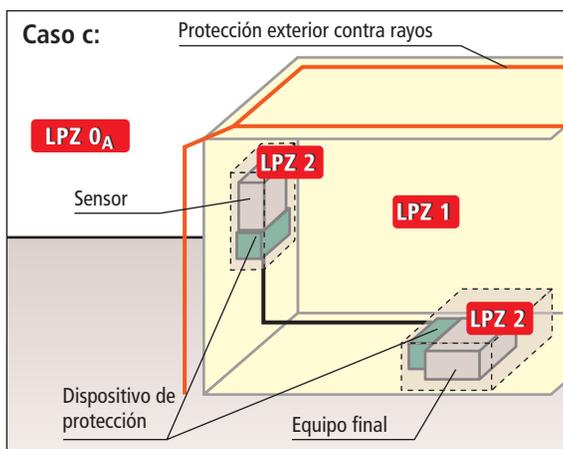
Edificio con protección externa contra rayos y cables en el interior del edificio, de acuerdo con el concepto de zonas de protección contra rayos.
